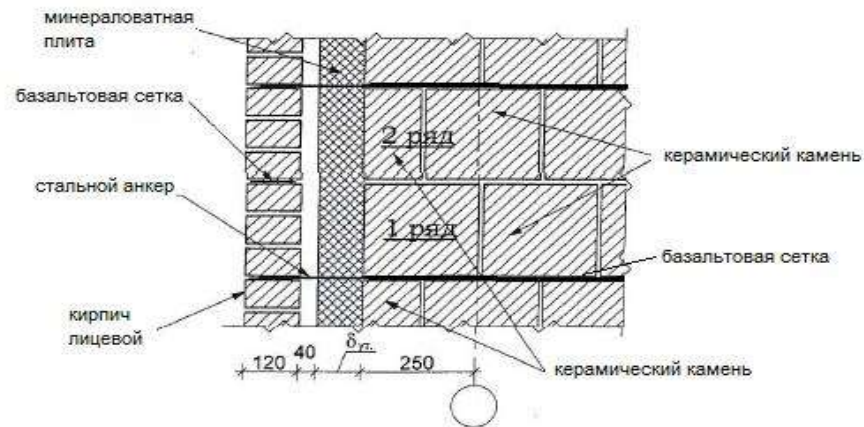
Узлы сопряжения внешнего слоя с внутренним в трехслойной стене
